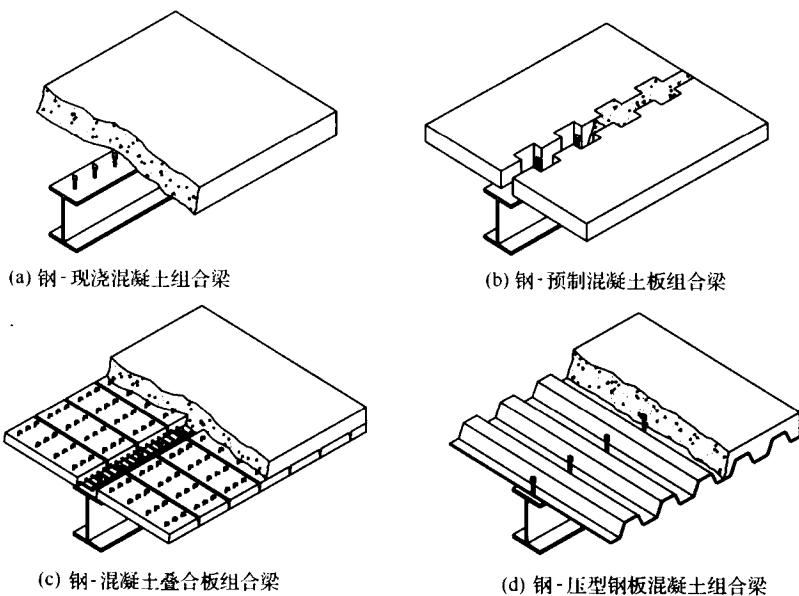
不同混凝土翼板的钢-混凝土组合梁截面形式
